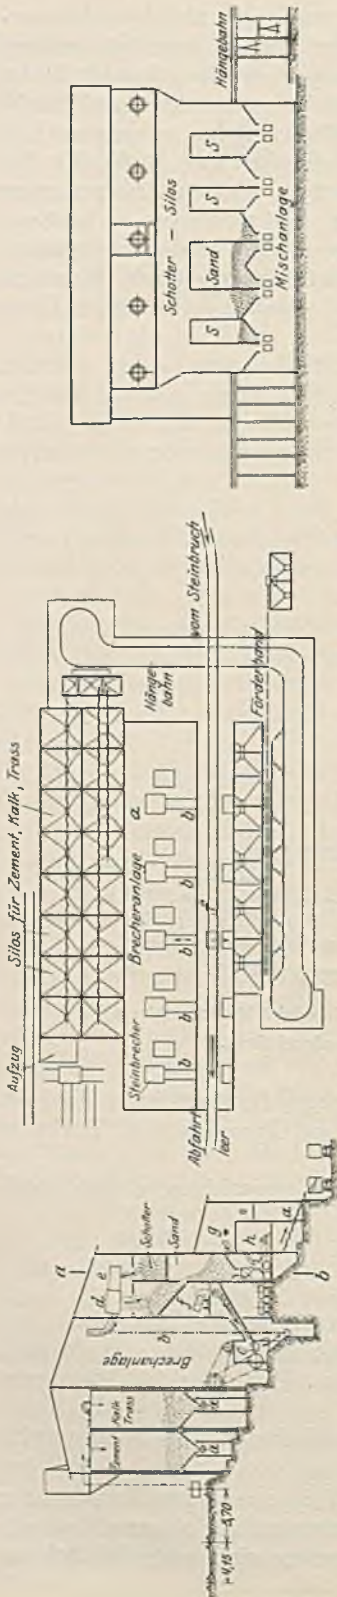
Betonfabrik der Siemens-Bauunion an der Schwarzenbachsperrre.
